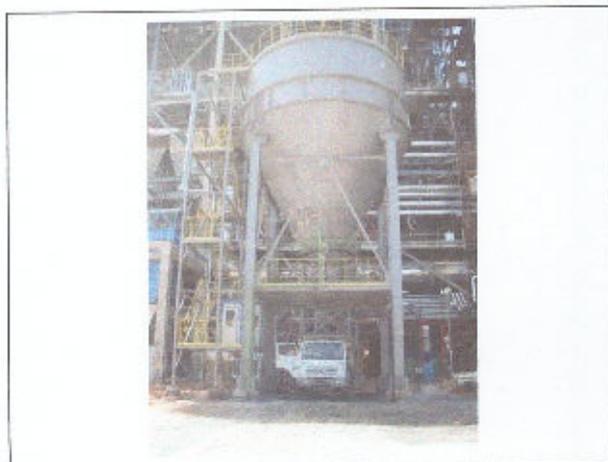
Área do Silo de Cinza Pesada - acesso em fase de pavimentação
